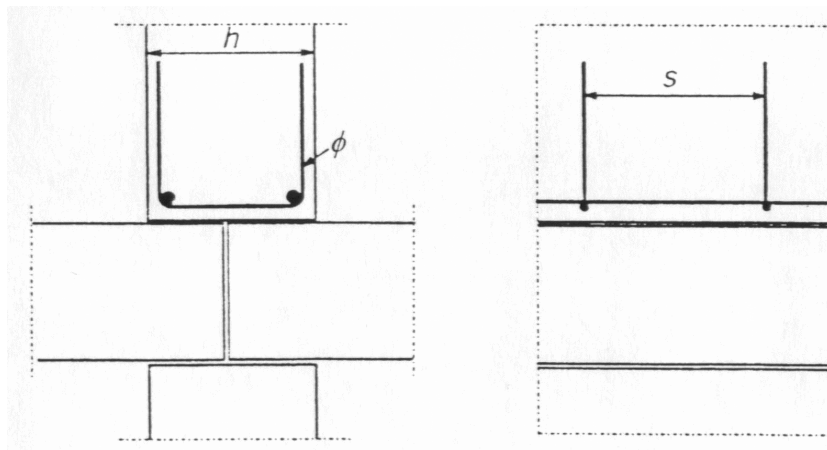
Приклади армування стіни над стиком між двома плитами перекриття
